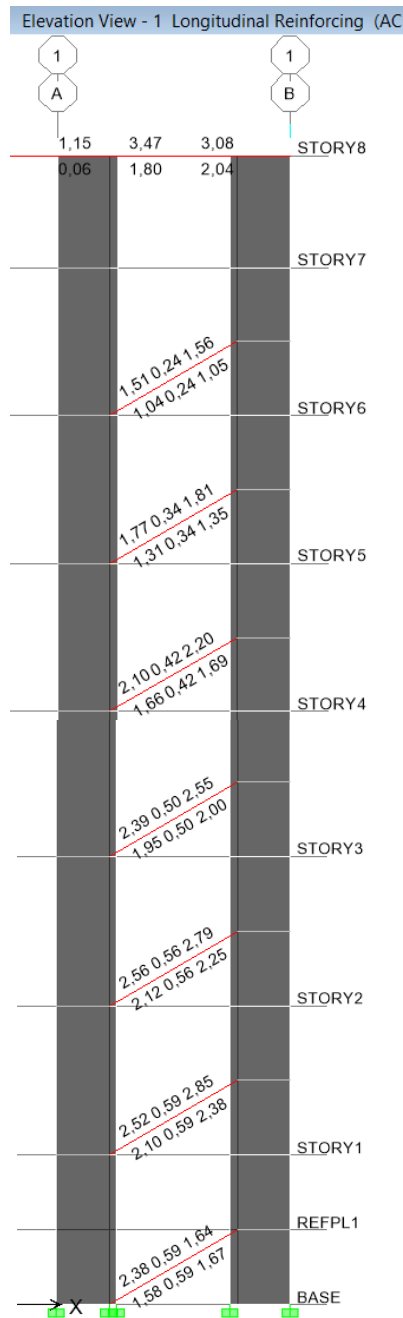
Acero en Vigas y Columnas en el Pórtico 1 – Escaleras de Emergencia Hospitalización 2- (NEC-11)
